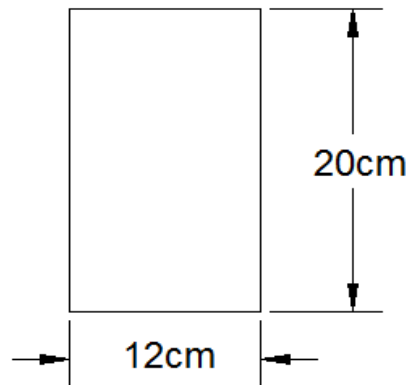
Coupe schématique de la poutrelle (appuis)
